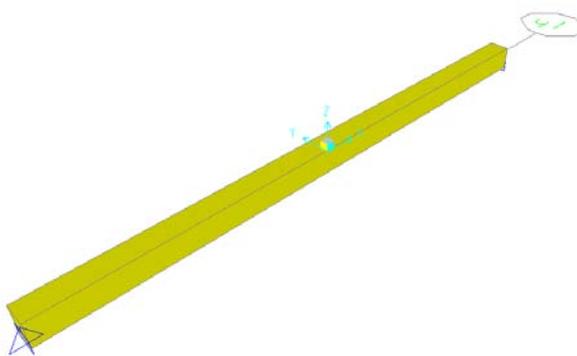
VIGA DE SECCION RECTANGULAR
